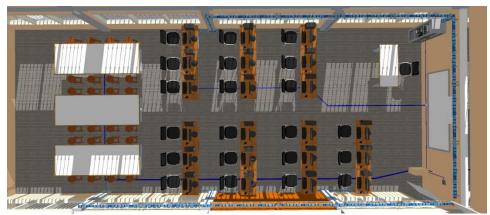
Vista Aérea del Laboratorio de Cómputo con Cableado Estructurado Fuente: Elaboración Propia DMP
